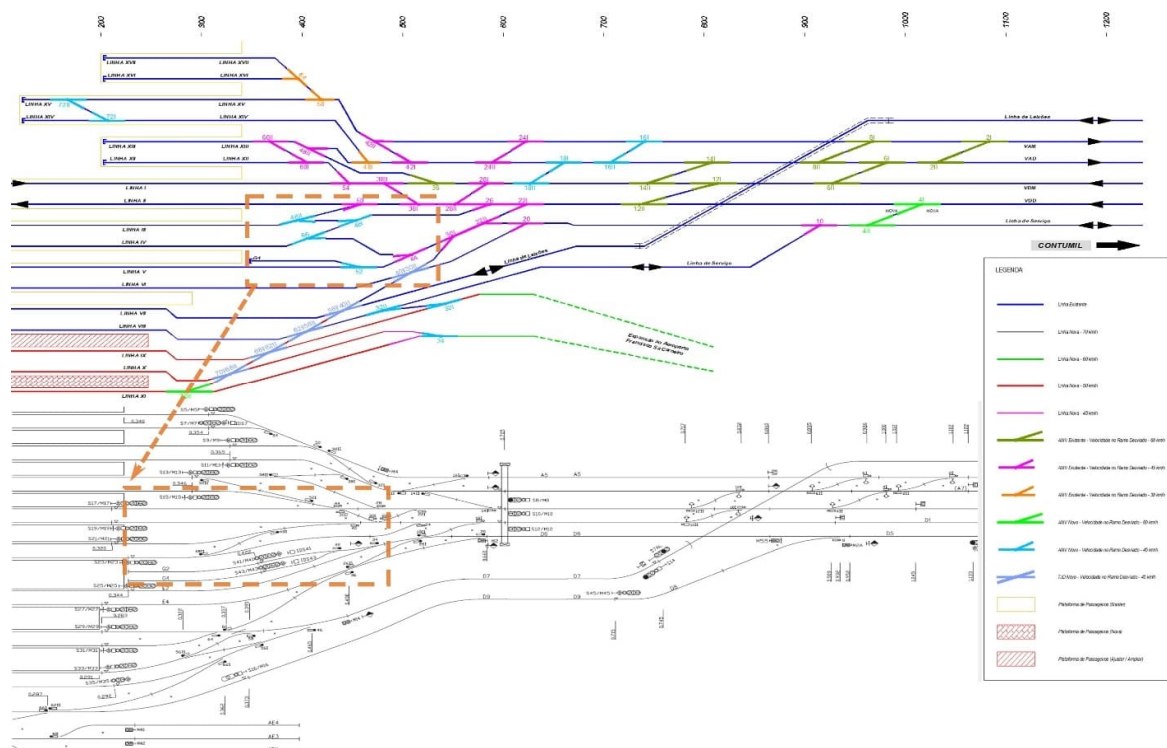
Zona Norte – Zona de Ligação entre o alinhamento da Estação e a zona Norte da Estação
